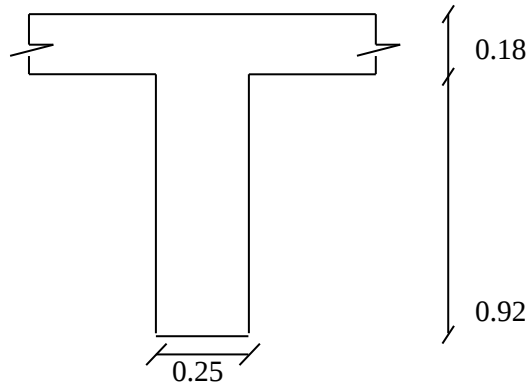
Sección Transversal del diafragma sobre el apoyo (m).
